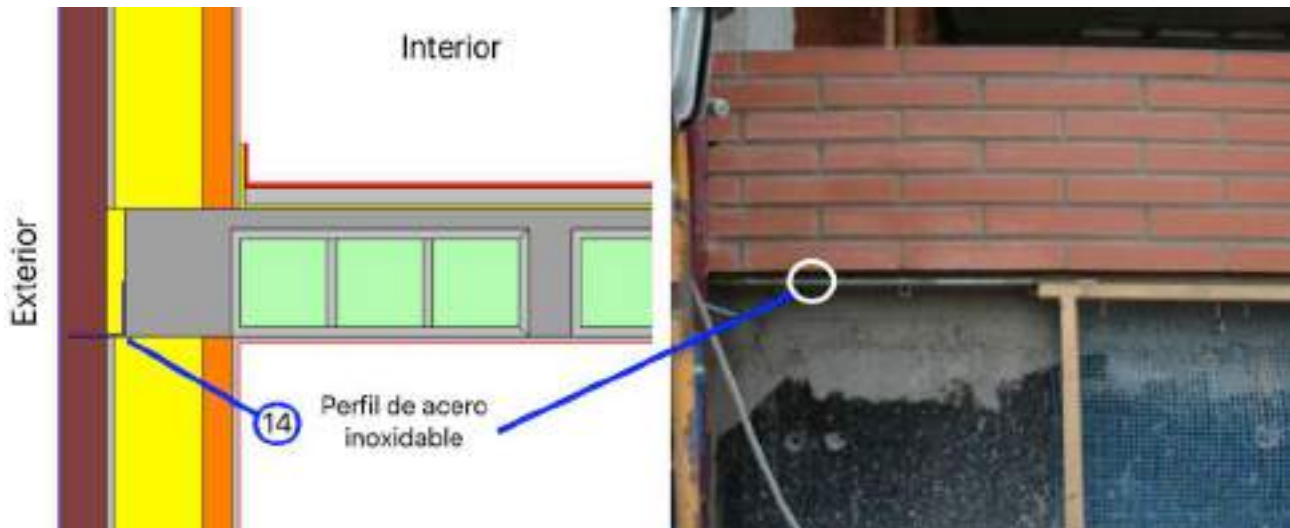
Mejora M1 considerada para reducir el puente térmico de frente de forjado con fachadas caravista. Detalle para el caso de forjados reticulares. Izquierda: esquema de la Mejora M1. Derecha: detalle del perfil de acero inoxidable.
